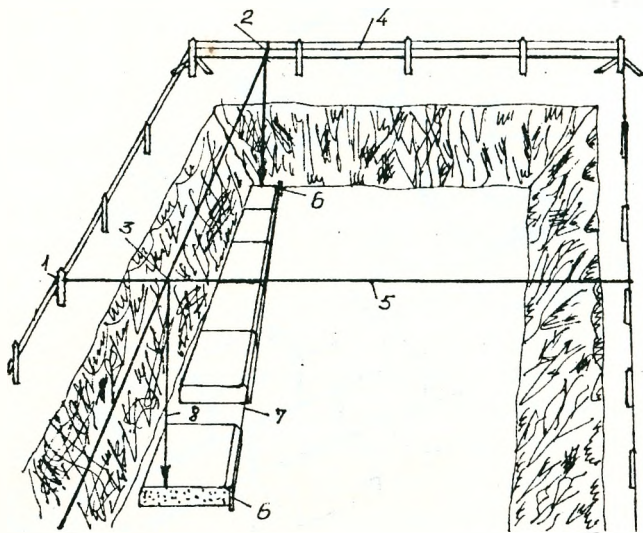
Перенесение осей фундамента на дно котлована.
